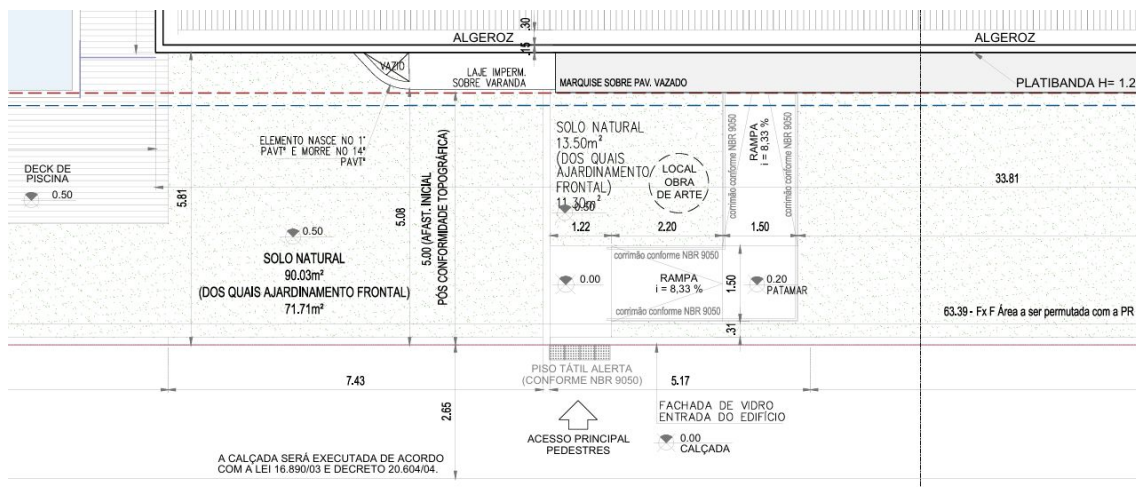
Trecho da Planta de Locação – Afastamento adotado na testada da rua Epaminondas de Melo (face do corte). Fonte: Processo nº 8036748824.
